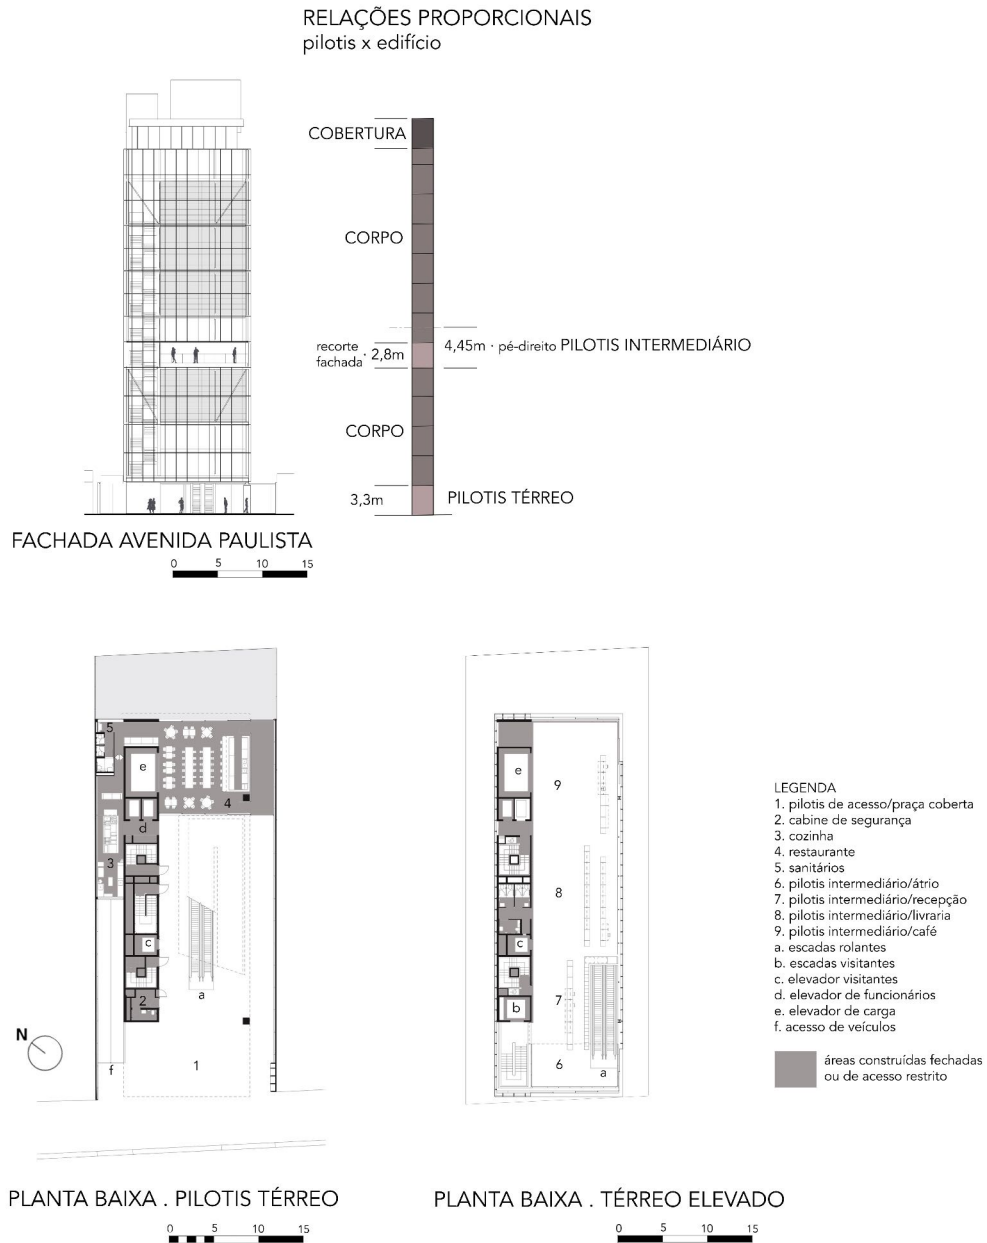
Plantas baixas do térreo, térreo elevado e fachada principal do IMS.
